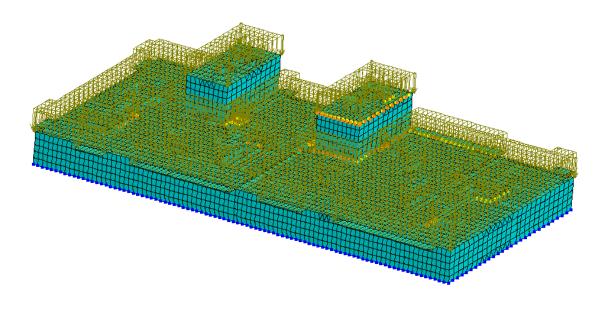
Расчетная схема плиты покрытия со снеговой нагрузкой
